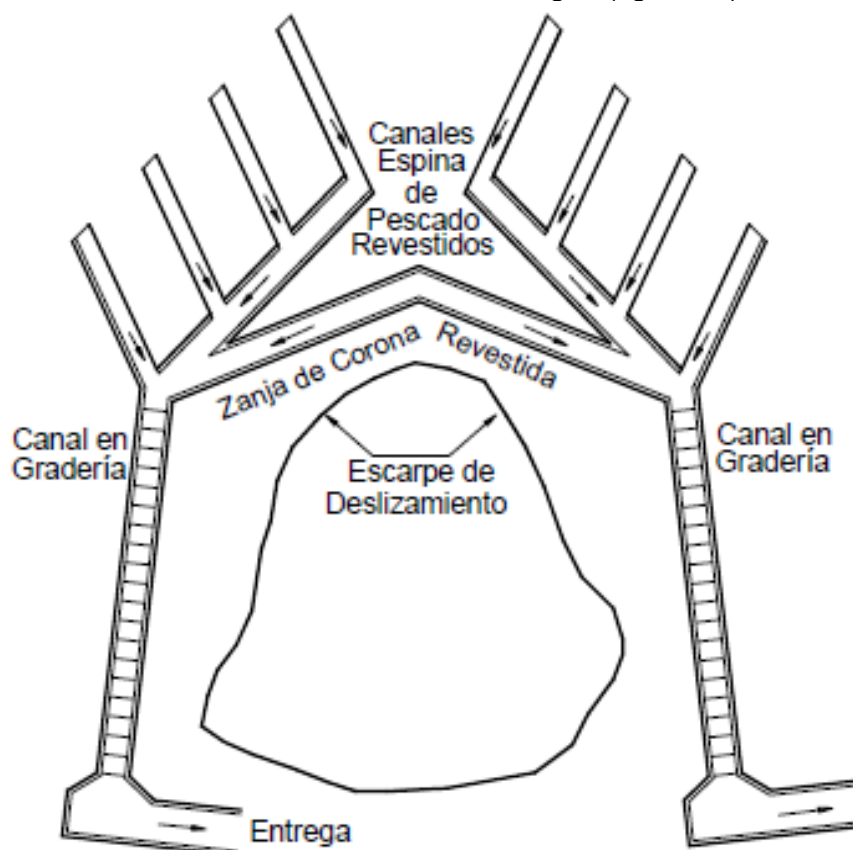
Esquema en planta de canales colectores Espina de Pescado (Suarez, 2010).
